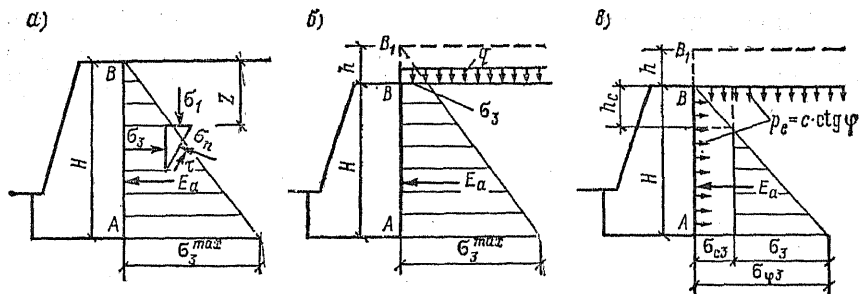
Схемы для определения давления грунта на гладкую подпорную стенку
